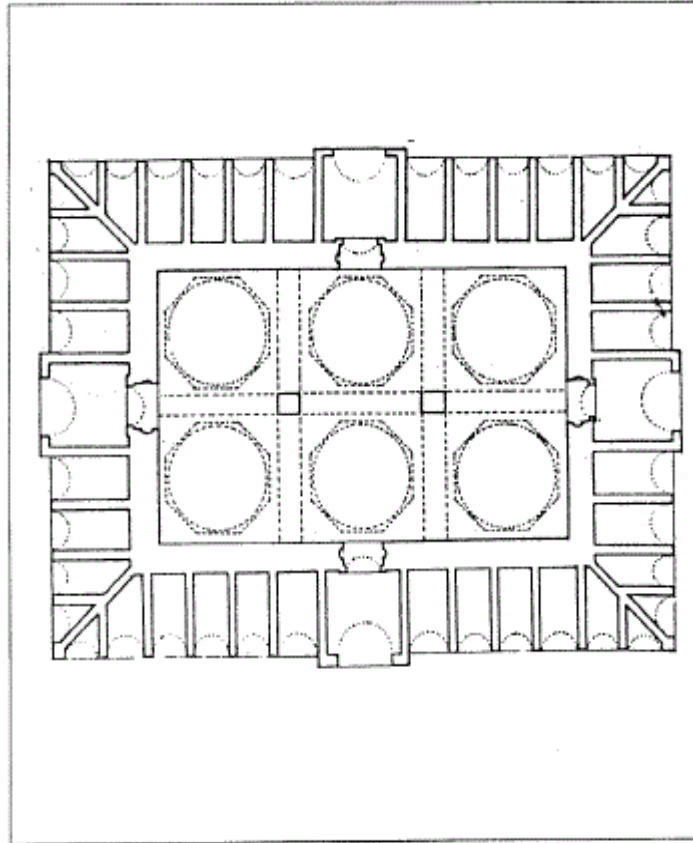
مسقط أفقي لصندل بادستان باستانبول (عن: Cezar).
